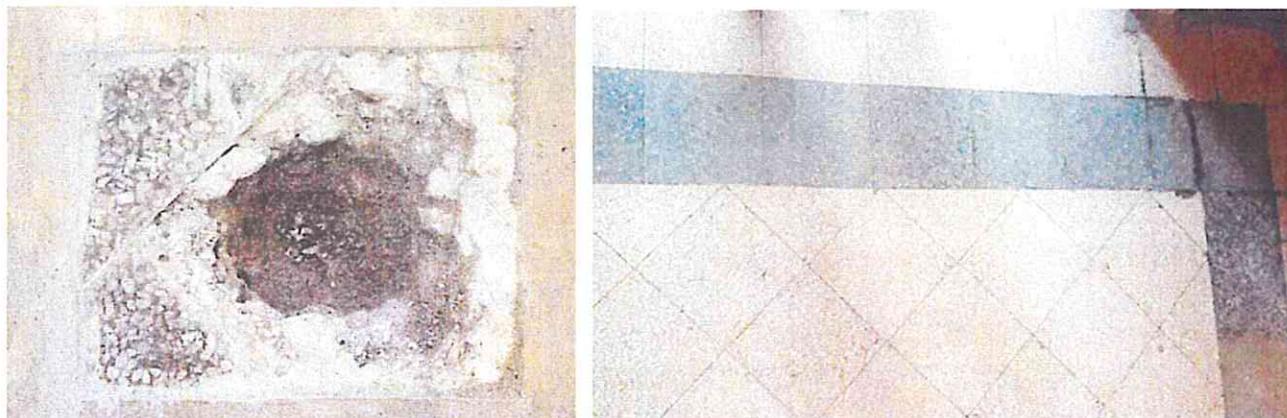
\_Saggio stratigrafico delle pavimentazioni: (A sinistra) immagine del saggio effettuato con evidenziata la pavimentazione esistente (a destra) pavimentazione presente nei locali adiacenti e potenzialmente consimile con la pavimentazione esistente
